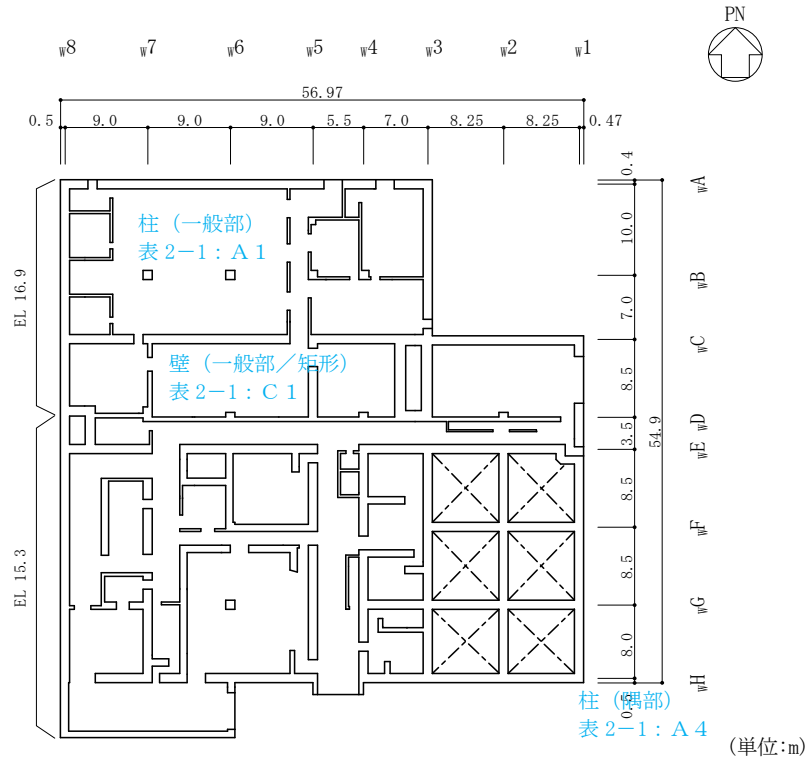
(4) 廃棄物処理建物の概略平面図 (EL 15.3m, EL 16.9m)
